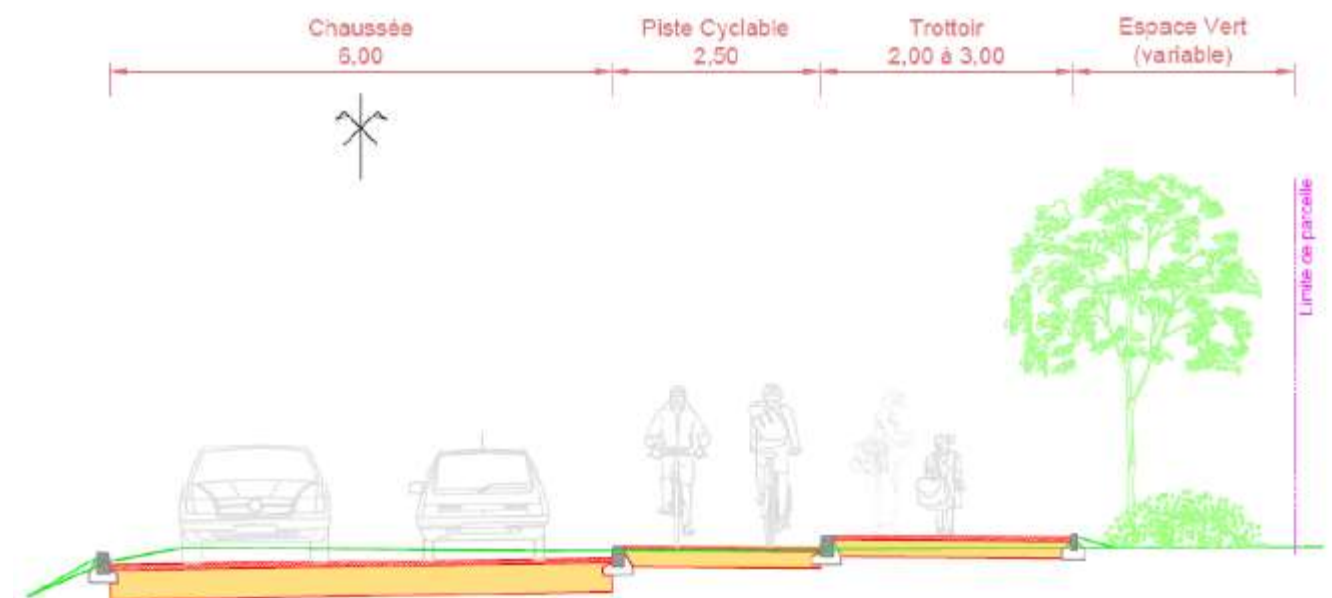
Coupe de principe du barreau "Marcellin Allo"
